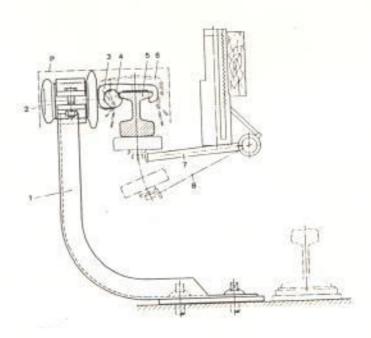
PUNTO DE APOYO DEL CARRIL DE CONTACTO.
